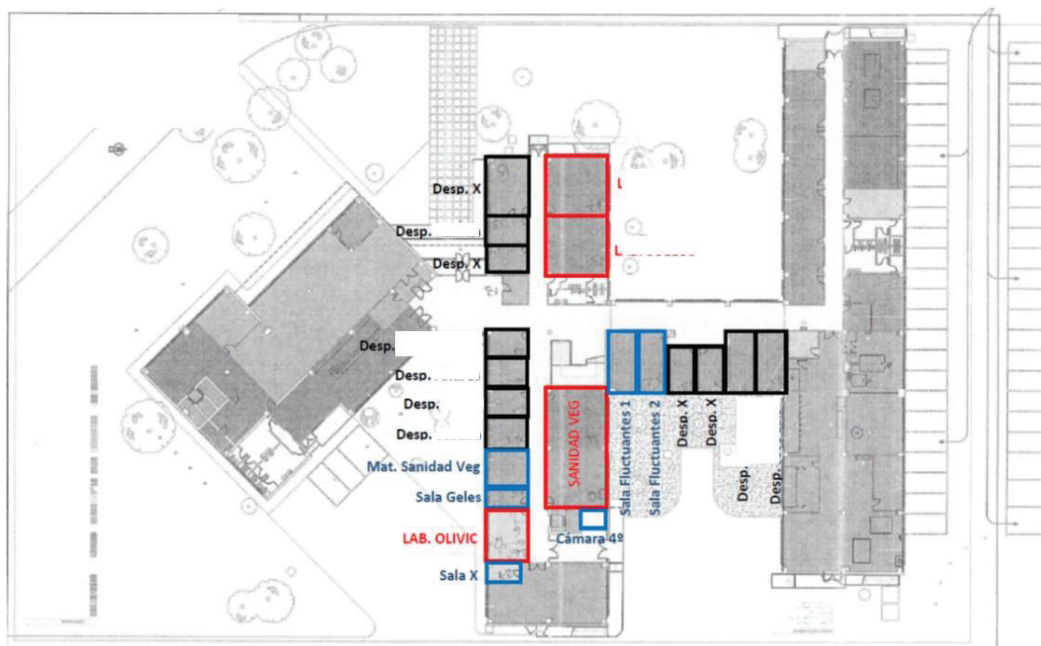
Planta del laboratorio de olivicultura con la posición de los elementos a instalar.
